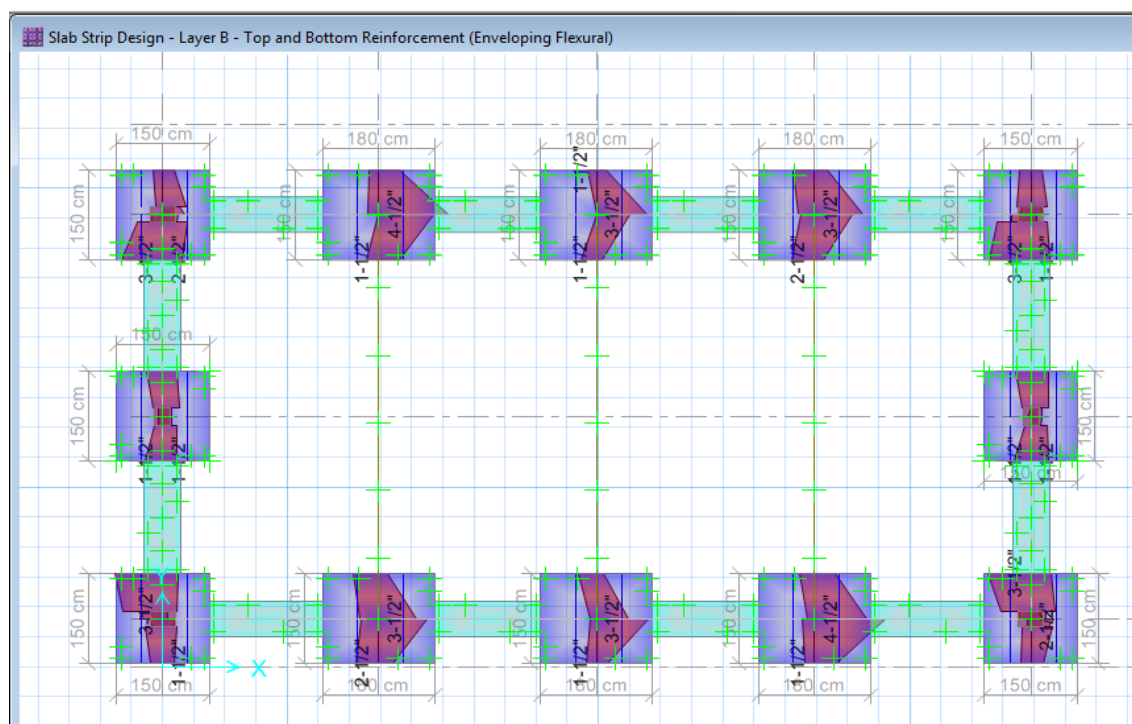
Refuerzo en cm² de cimentación Módulo III
